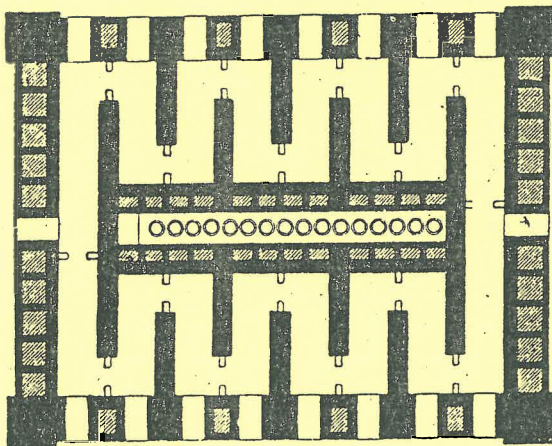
Zickzack-Ringofen mit 16 Kammern. Grundriß.
